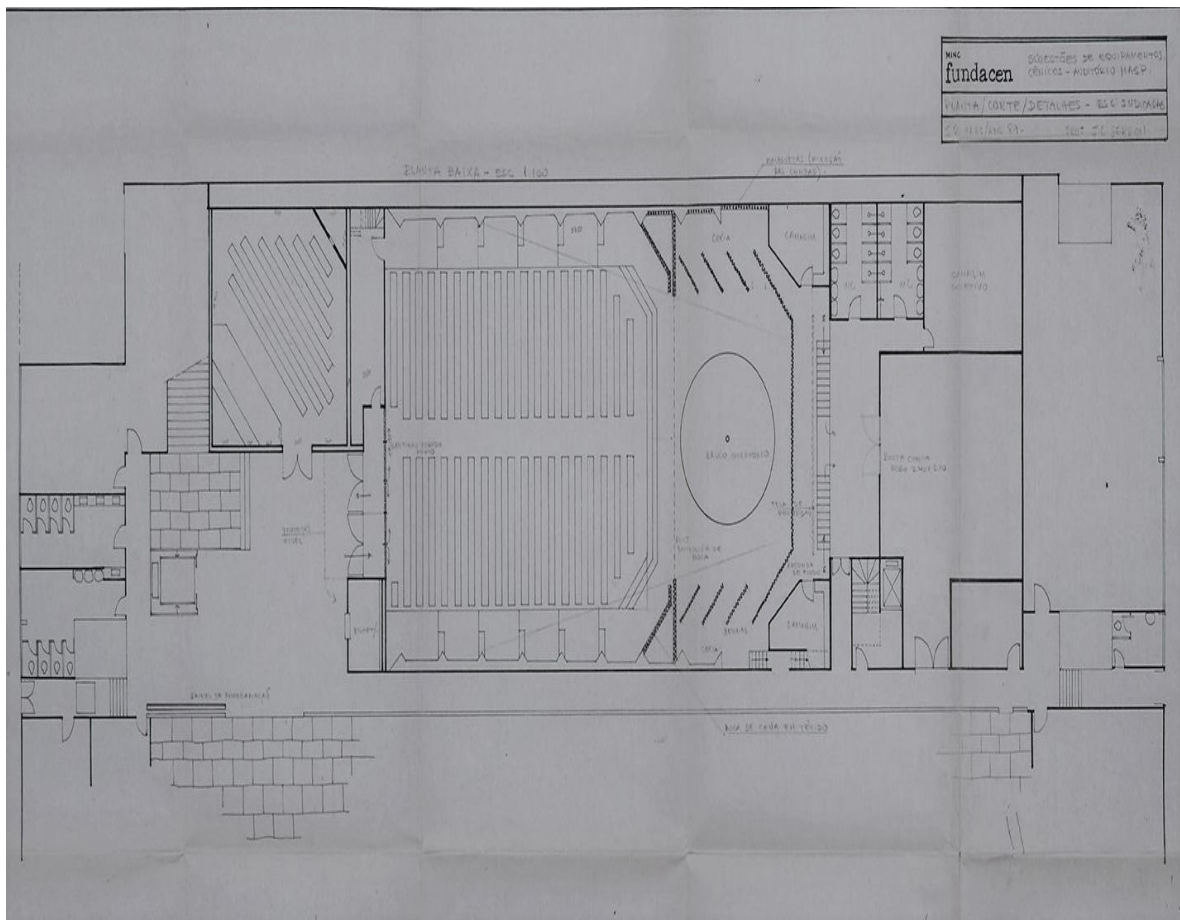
Museu de Arte de São Paulo, planta piso 1.
